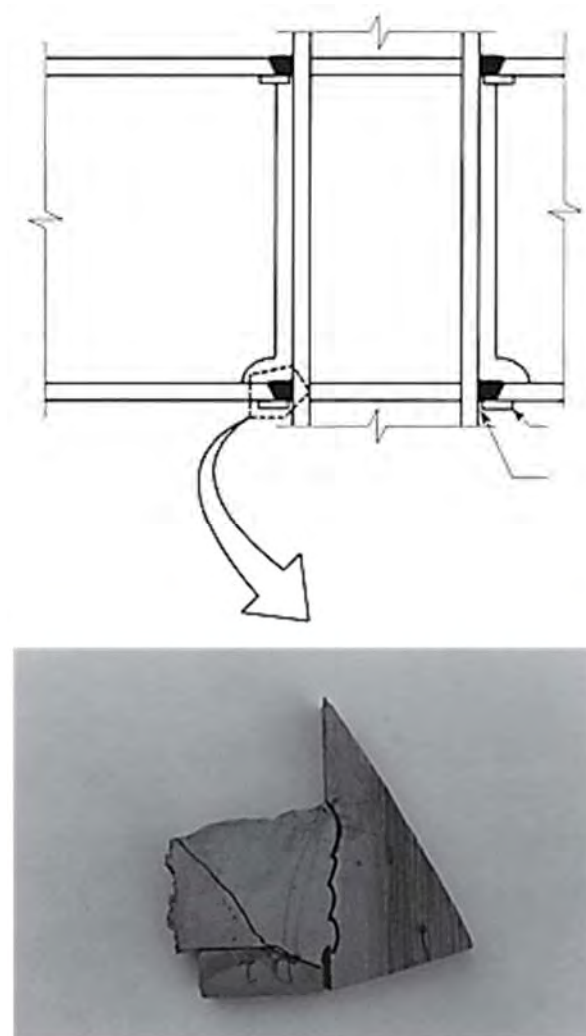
Ejemplo de patín inferior de viga fracturada con una grieta originada en el espacio entre la orilla de la barra de respaldo de la soldadura y el patín de la columna (Tamboli 2010).
